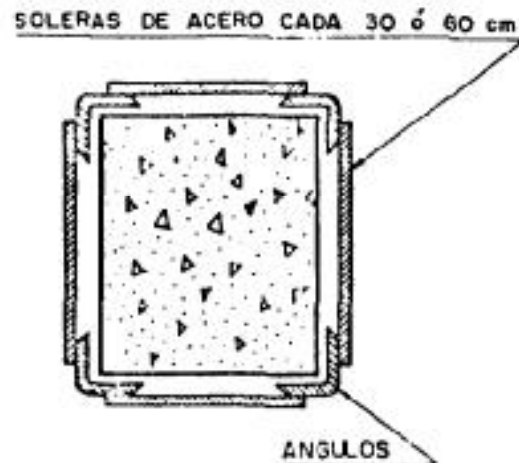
Apuntalamiento con ángulos y soleras de acero
